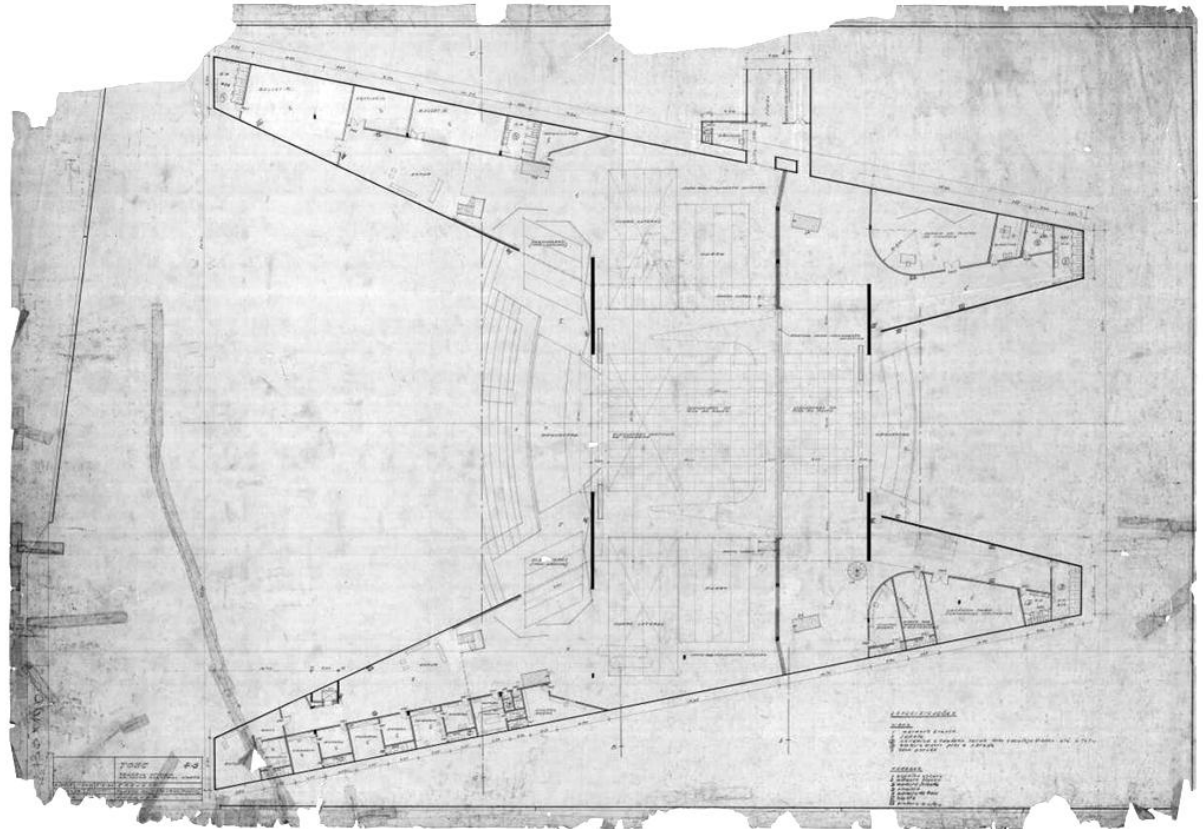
Planta Baixa - Subsolo 3 (1960). Carimbo: Teatros Oficiais no Setor Cultural Norte, TOSC, 4.3. Conteúdo: Planta da cota -9,00. Data: 07/06/1960. Fonte: ARPDF.
